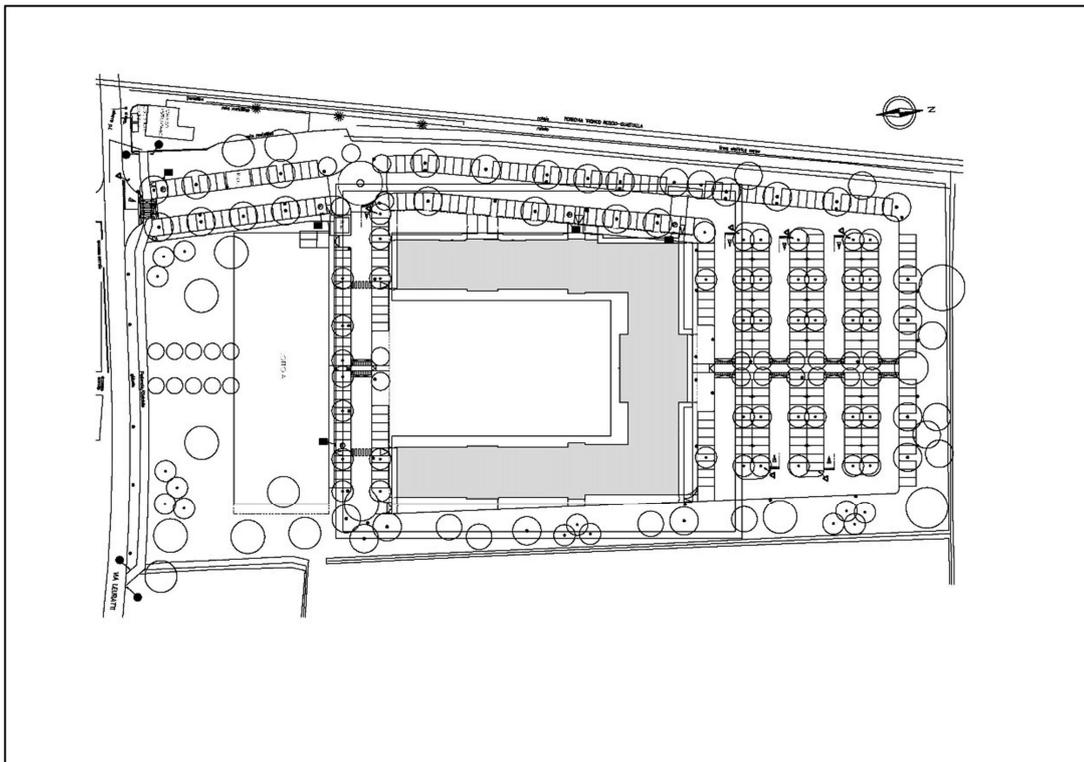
Planimetria sede legale di Reggio Emilia, via Rochdale 3-5
